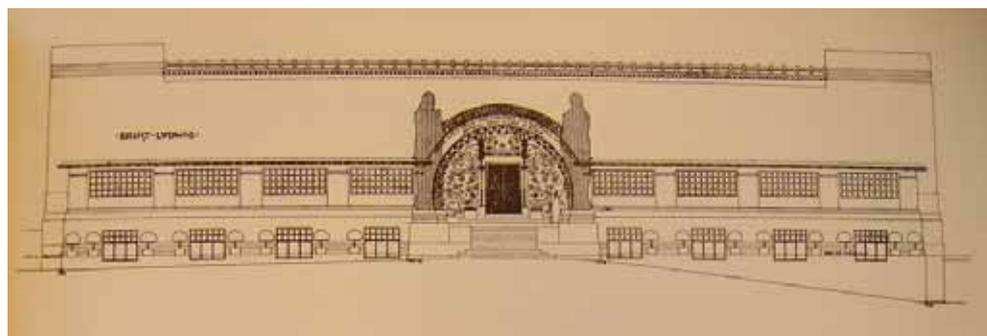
Plano de Fachada Frontal del edificio Ernst Ludwig Haus en la Matildehöhe, diseñada por J. M. Olbrich, en 1901
